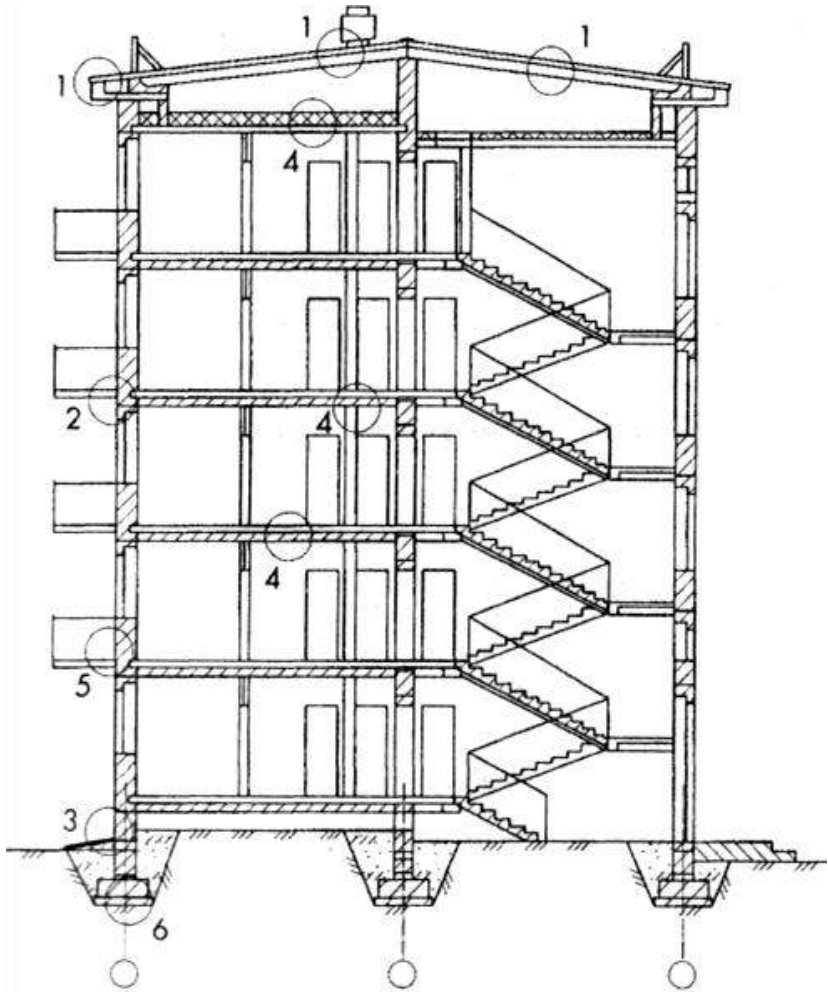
Найбільш характерні слабкі місця, з яких починається руйнування конструкцій будівлі: 1 – на даху; 2 – на балконі; 3 – на цоколі; 4 – в перекритті; 5 – на стіні
